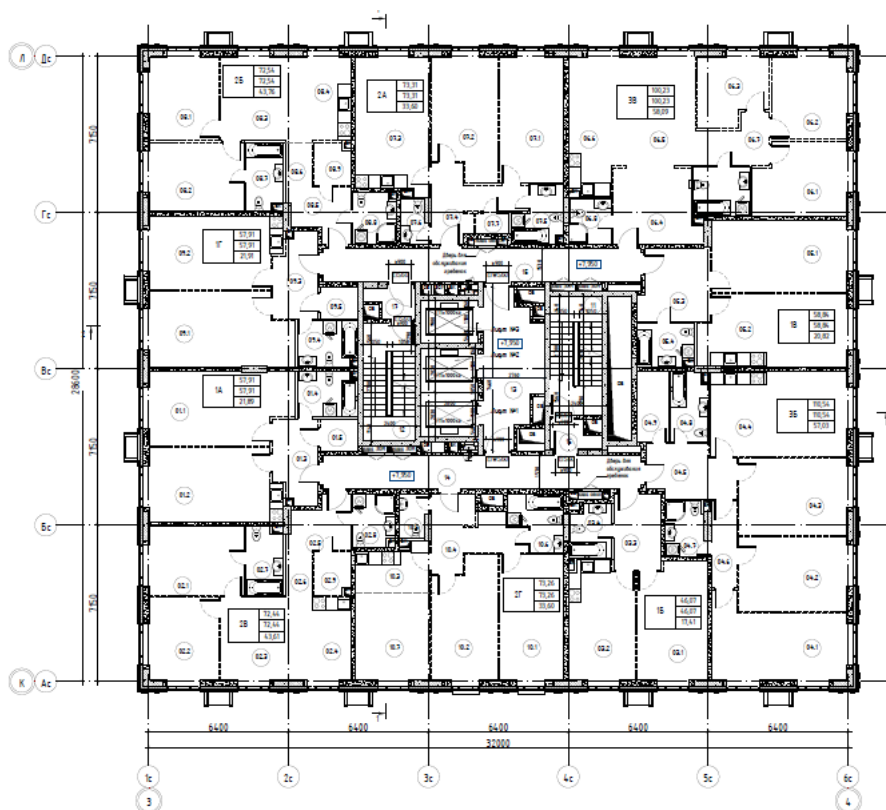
План 3-го – 22-го типового этажа корпуса 1
